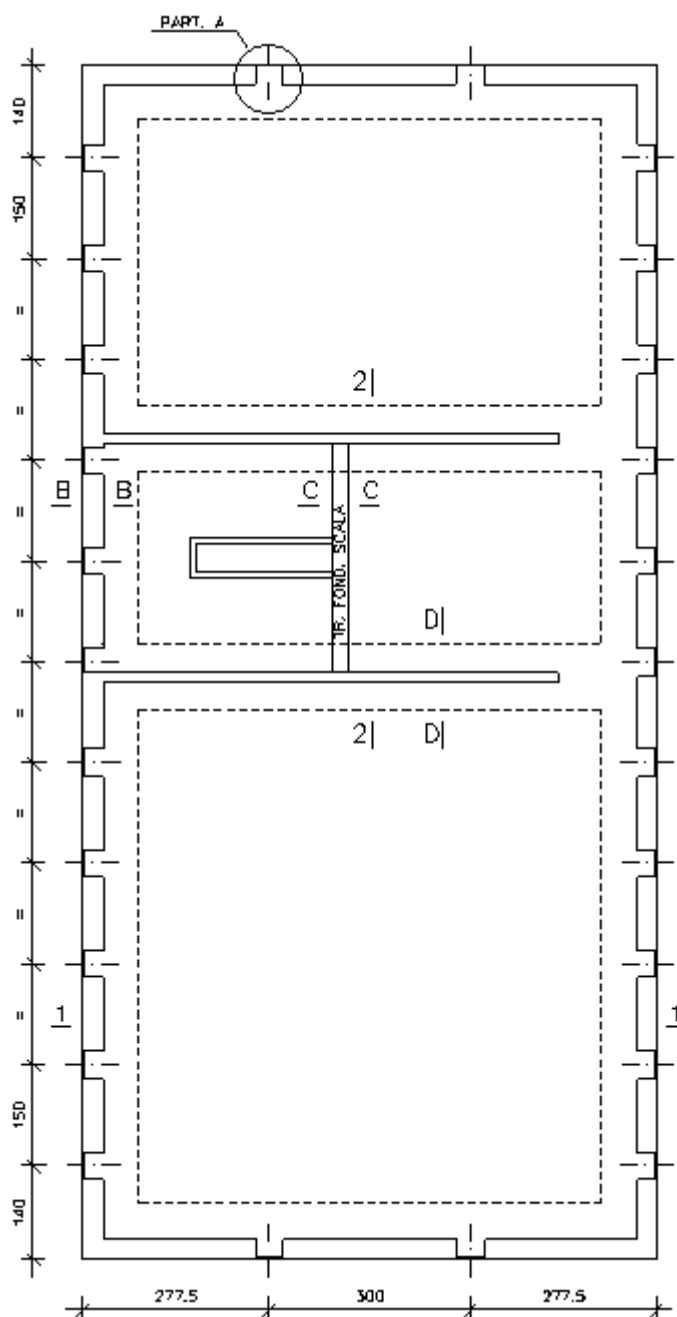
Ex-Lavanderie - stato di progetto: pianta fondazioni
